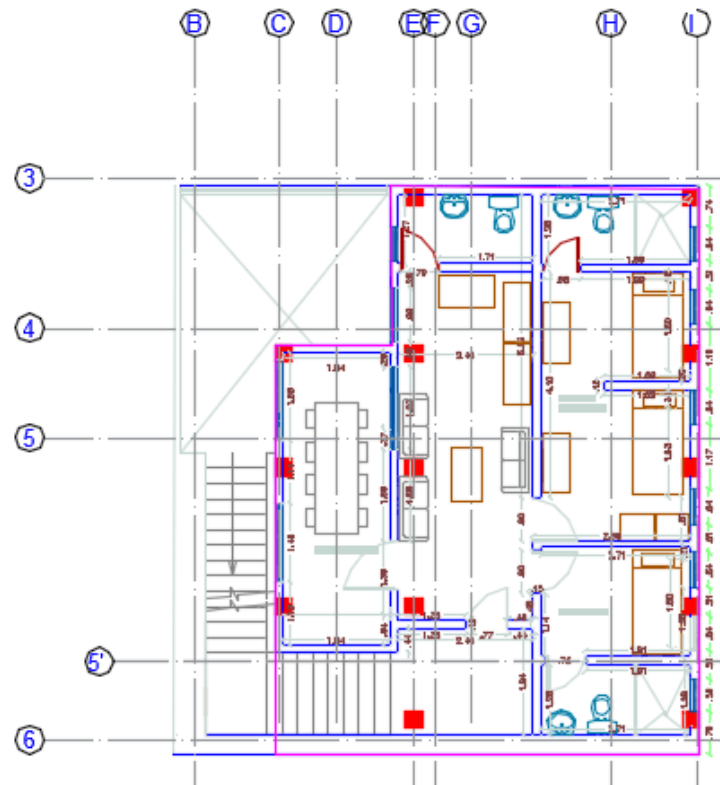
Planta Estructural y arquitectónica, con entrepiso en metaldeck de la Zona A, Mezzanine. Fuente:
